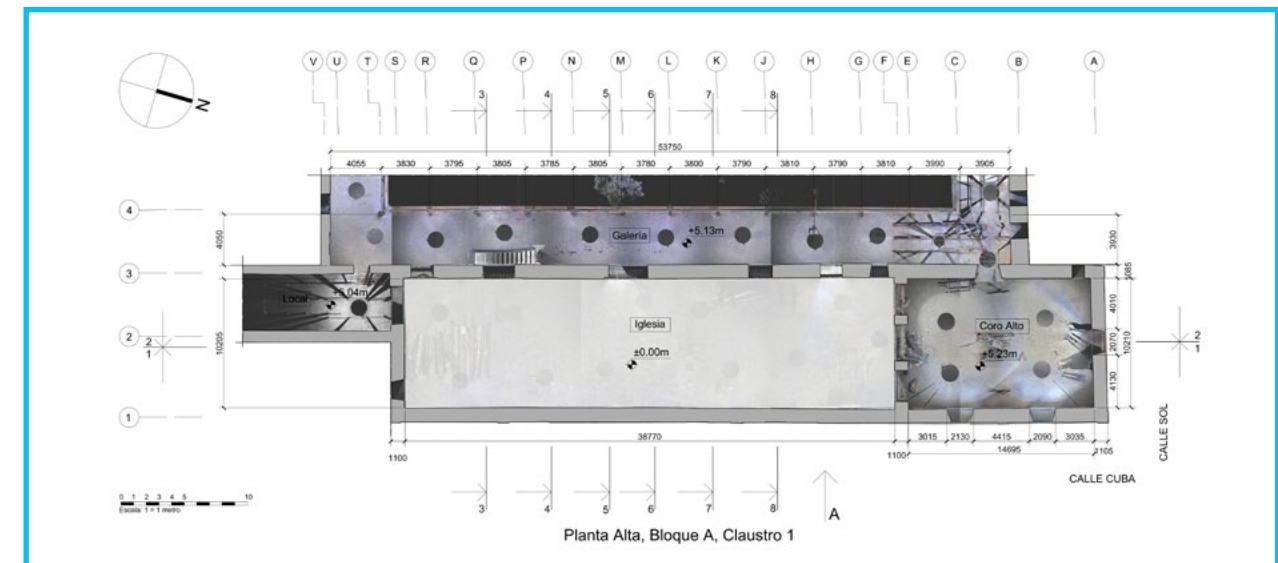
Ortoimagen obtenida de la planta alta, bloque A, primer claustro
